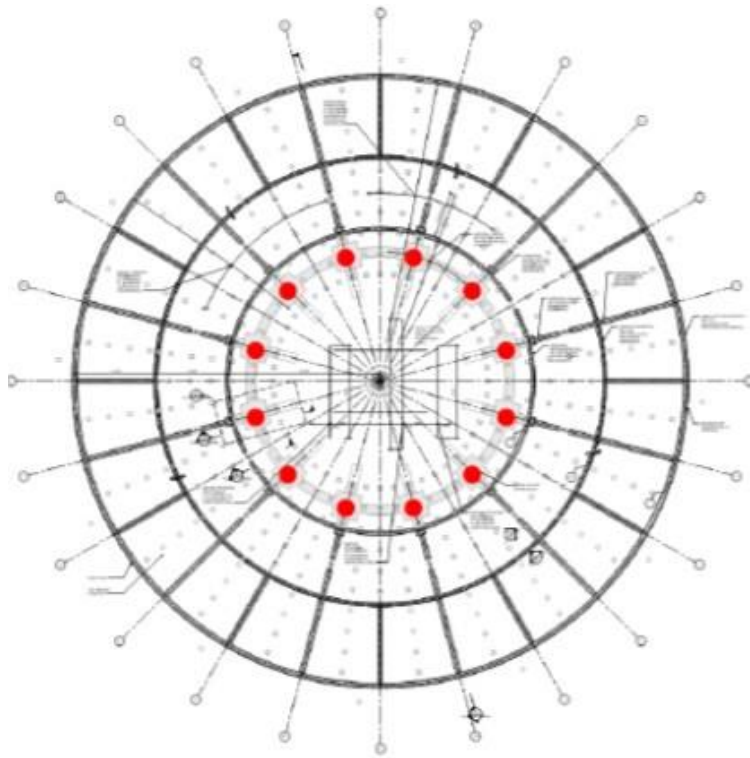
Plano de los cimientos que muestra la ubicación de los soportes de aislamiento (en rojo), Foster y Partners (2016).
